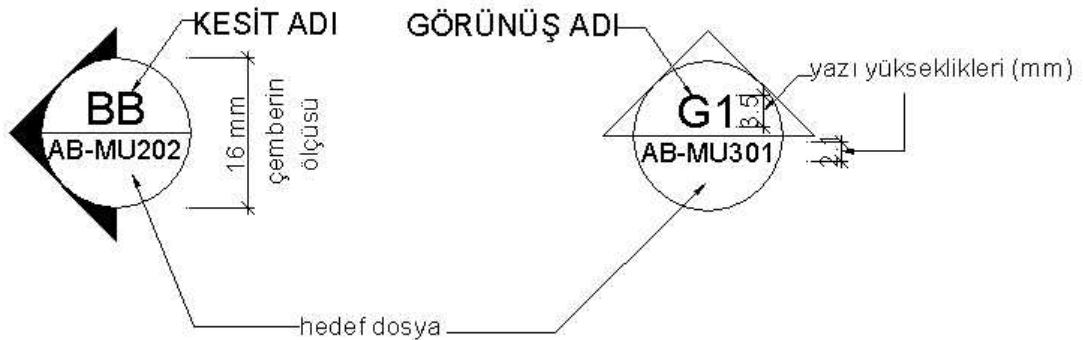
Kesit ve cephe sembollerinin plan üzerinde gösterimi
